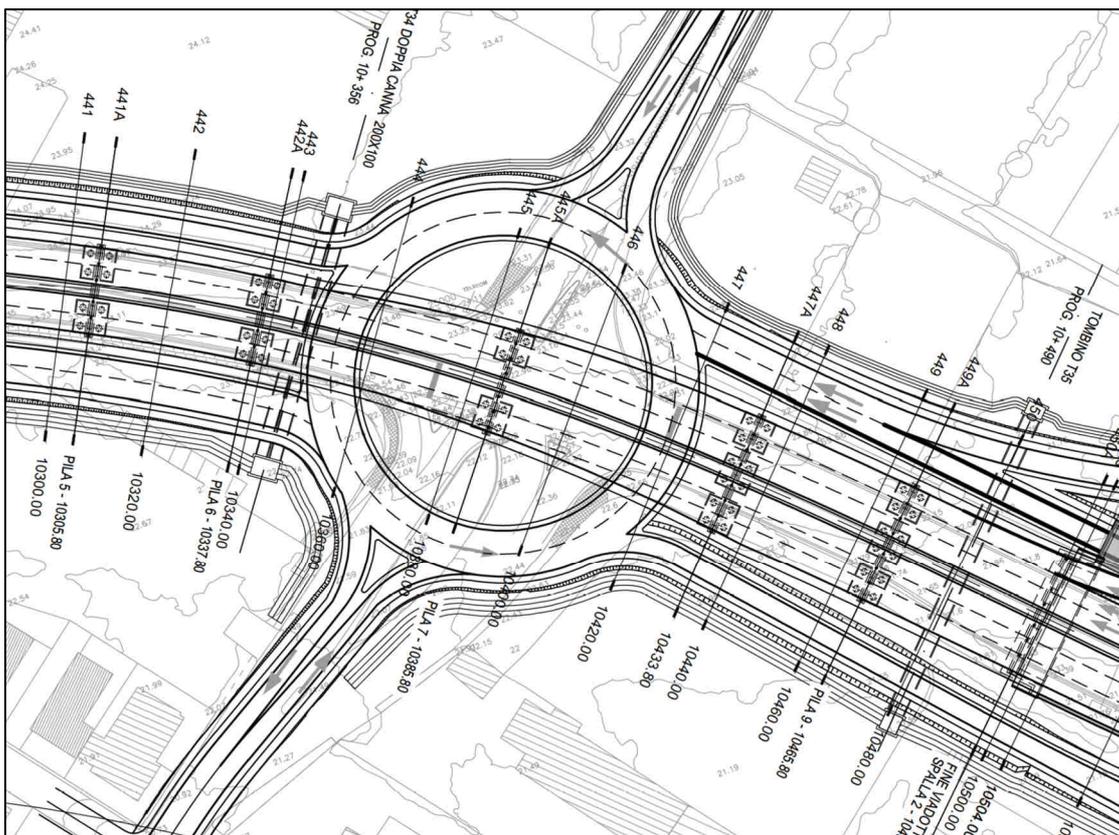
particolare dalla planimetria di progetto dell'area intorno alla rotatoria SV07
